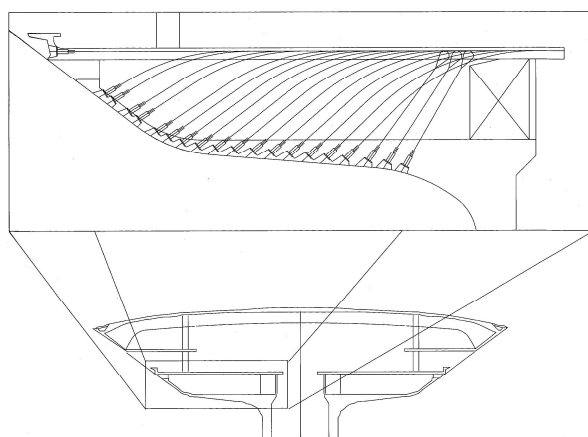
OSCAR NIEMEYER, 1991. MAC DE NITEROI, PLANTA 3, DETALLE ESTRUCTURA. (REF. ON.1991.ON.1997.049)
